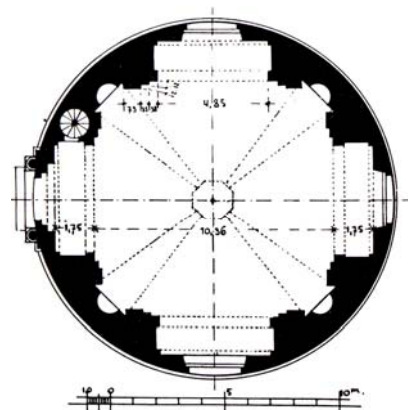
Gaibach, Kreuzkapelle Grundriss
